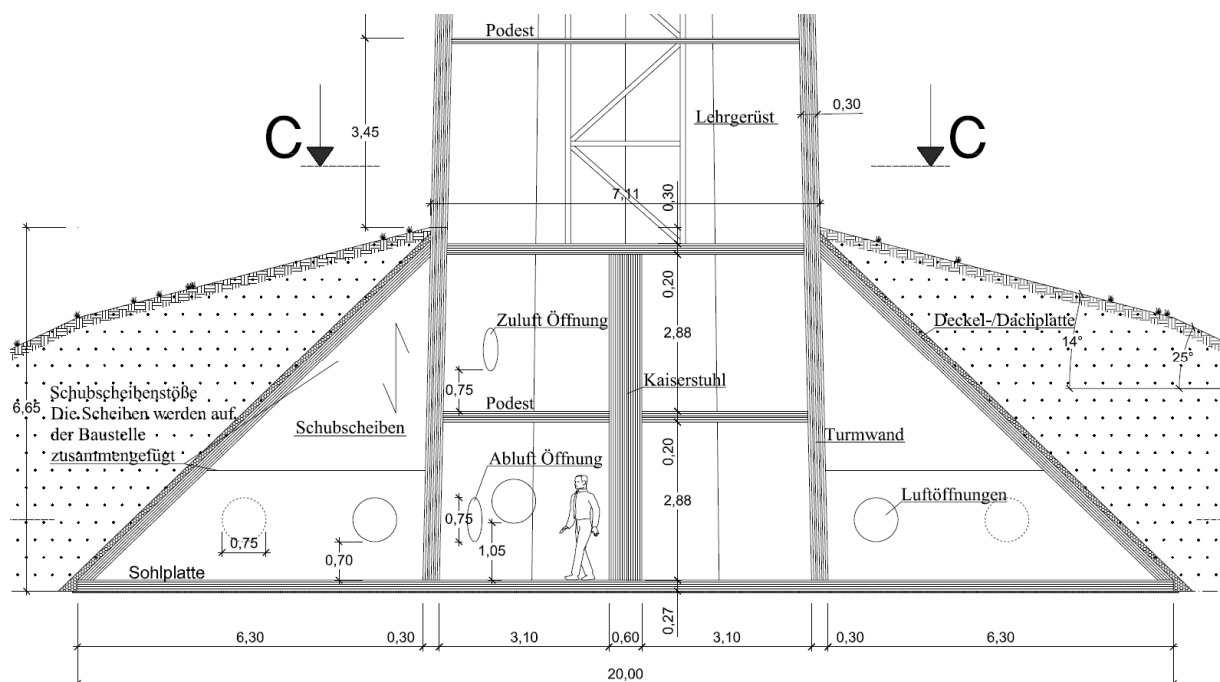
Konstruktionsaufbau im Fuß des Monolithen
